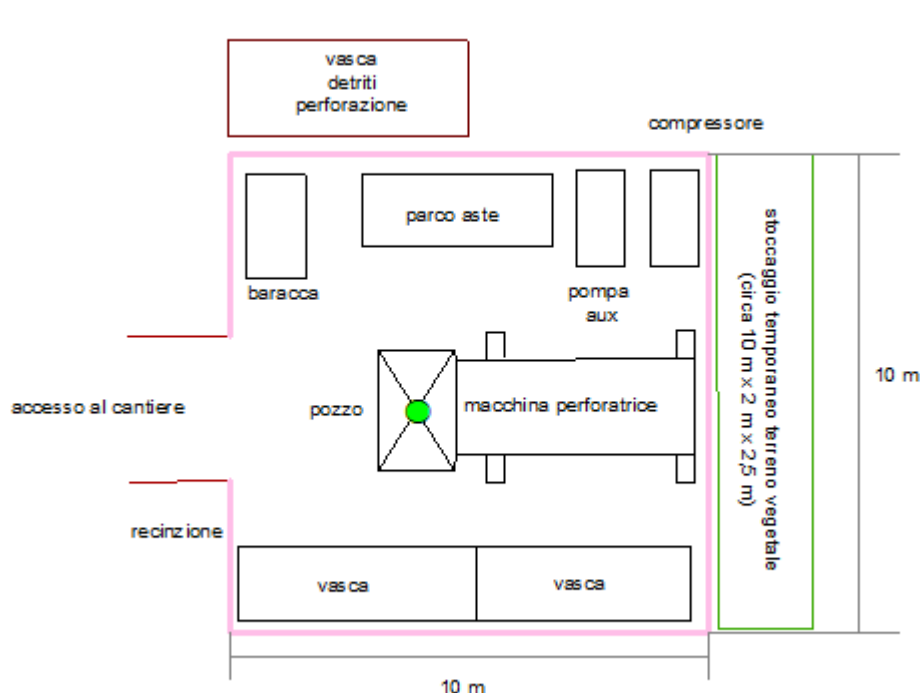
Layout di cantiere del pozzo 2 con i principali equipments (estratto da Allegato 1 – tavola schema cantiere)
